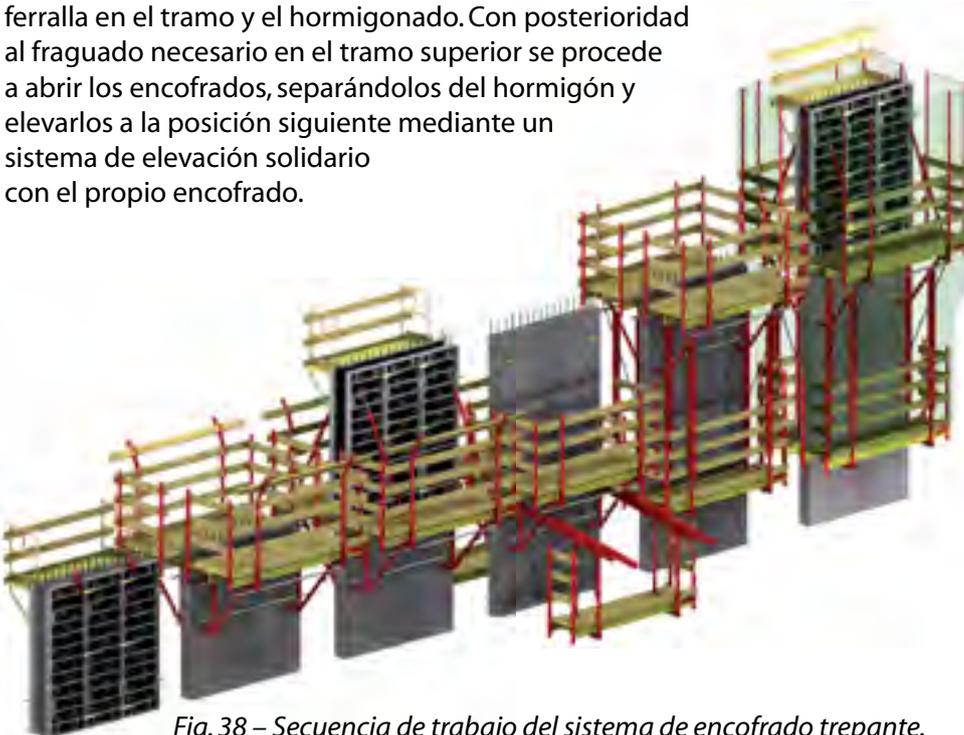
Secuencia de trabajo del sistema de encofrado trepante.
